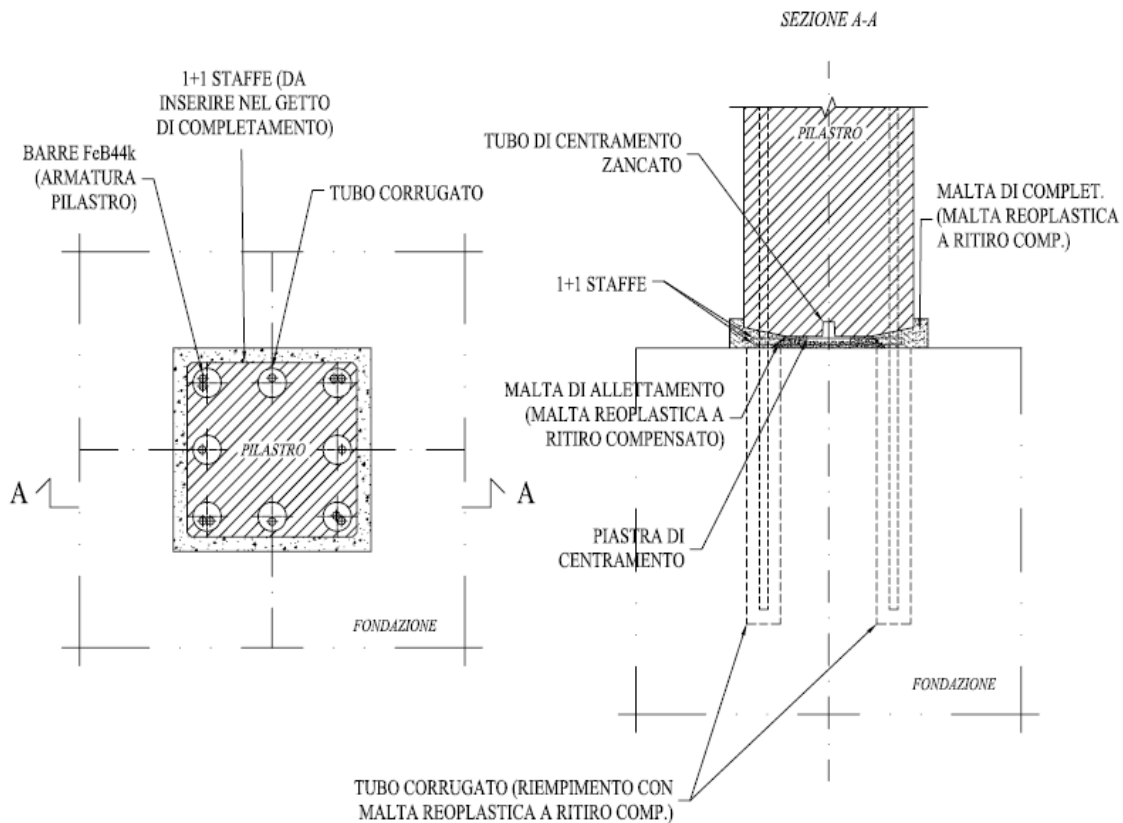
Collegamento tra platea di fondazione e pilastro realizzato mediante l'ammarraggio delle barre di armatura del pilastro in appositi tubi corrugati preinseriti nel getto della fondazione. Nei tubi viene posizionato il pilastro con l'ausilio di una piastra di centraggio. L'unione viene completata con il getto, sotto il pilastro, di malta reoplastica a ritiro compensato che ne garantisce l'appoggio completo sulla fondazione. (Toniolo, Palermo e Mandelli Contegni, 2007 [44])
